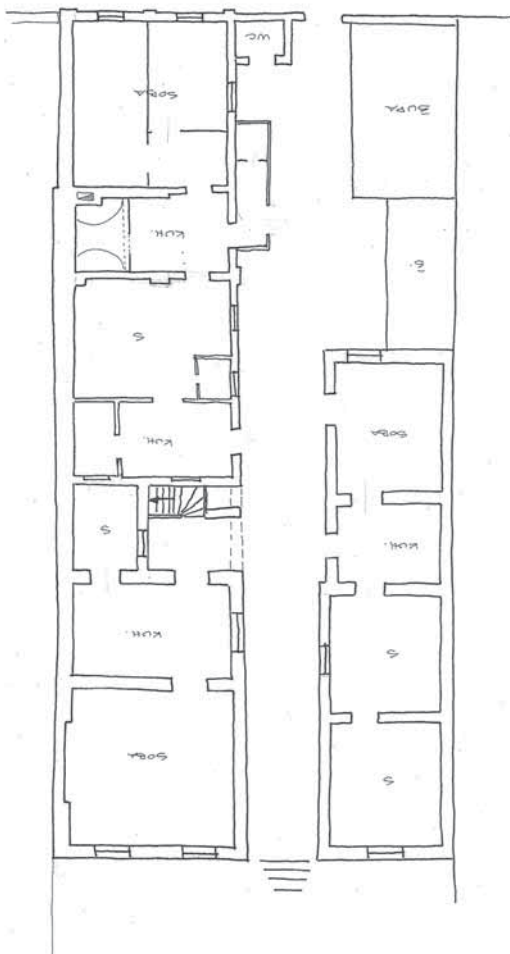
Matoševa 5, Lederer House, ground floor plan (MK-UZKB-KOZ)
